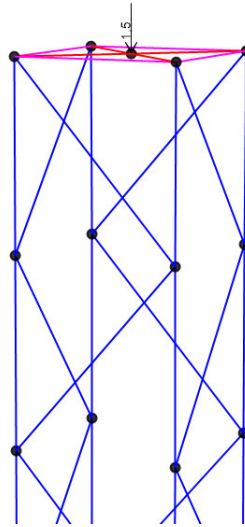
Disposición cargas de montaje y mantenimiento en soportes de equipos
